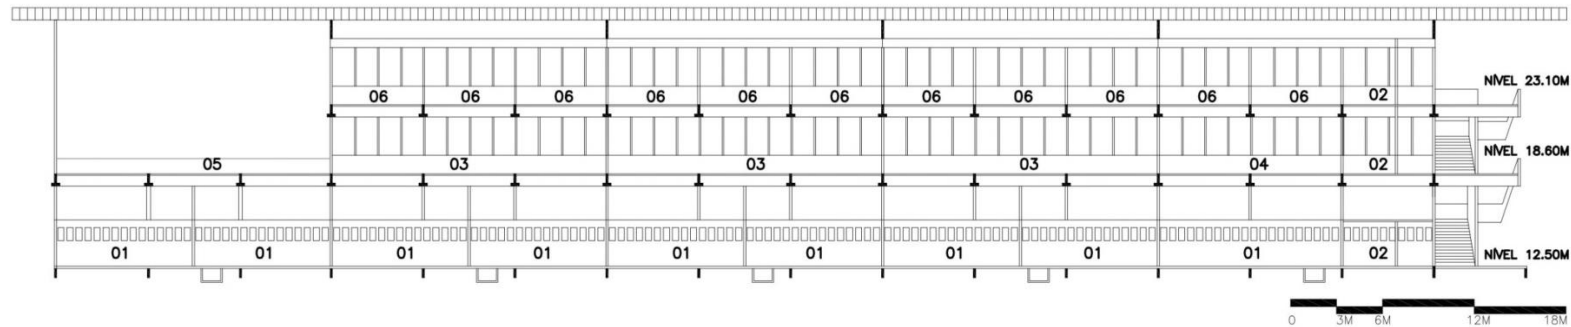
Corte C - Bloco Didático Plano UMA. Fonte: Prancha 16 do Plano de Implantação Imediata – 1º Sub-Etapa Plano UMA – Arquivo digital disponível no COMCAP-UEM.
